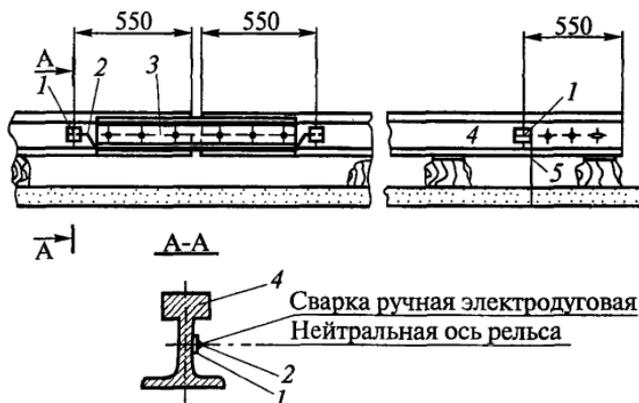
Приварка заземляющих проводников и перемычек к рельсам: 1 — промежуточная пластина; 2 — перемычка; 3 — накладка, 4 — рельс; 5 — заземляющий проводник
